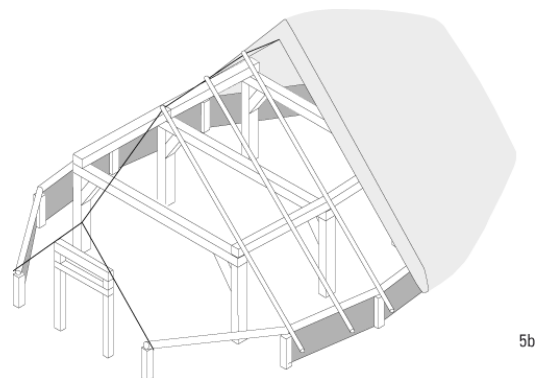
Reconstructietekening van gebouw 5b uit Lieshout (Hiddink 2005, 159 fig. 8.3).
